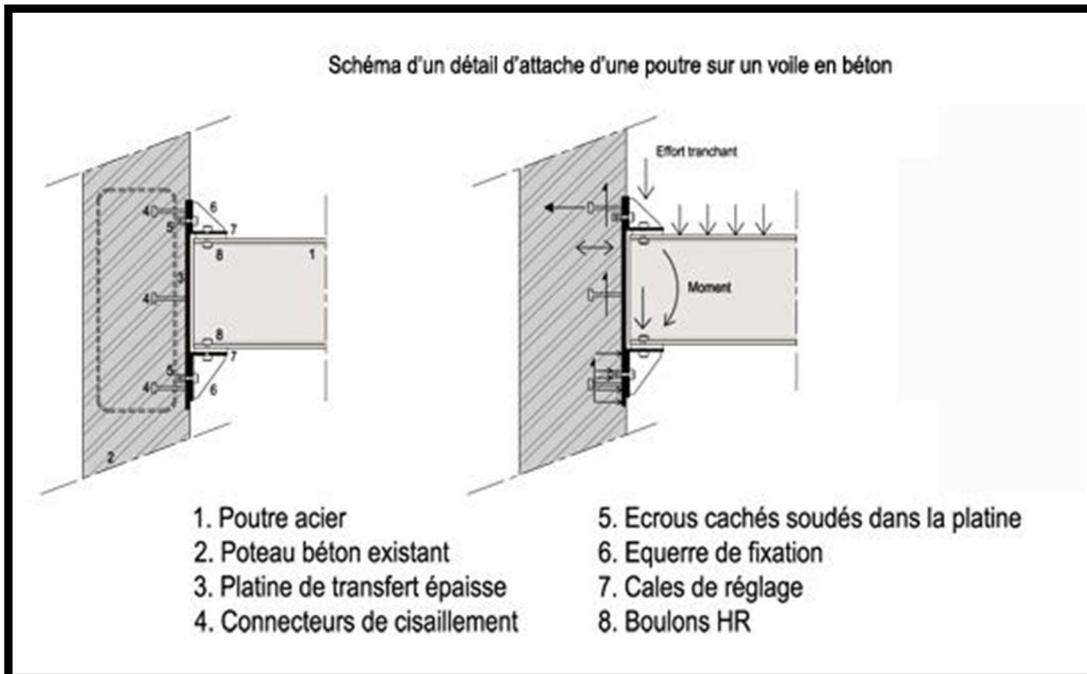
schéma du détail d'attache d'une poutre sur un poteau en béton.
